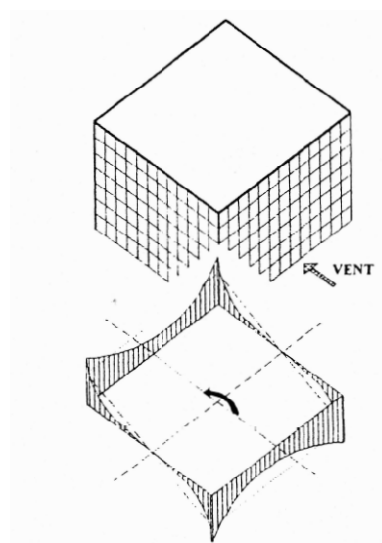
Effort axiaux dans les poteaux de façades d'une ossature à tube (effet de trainage de cisaillement)
